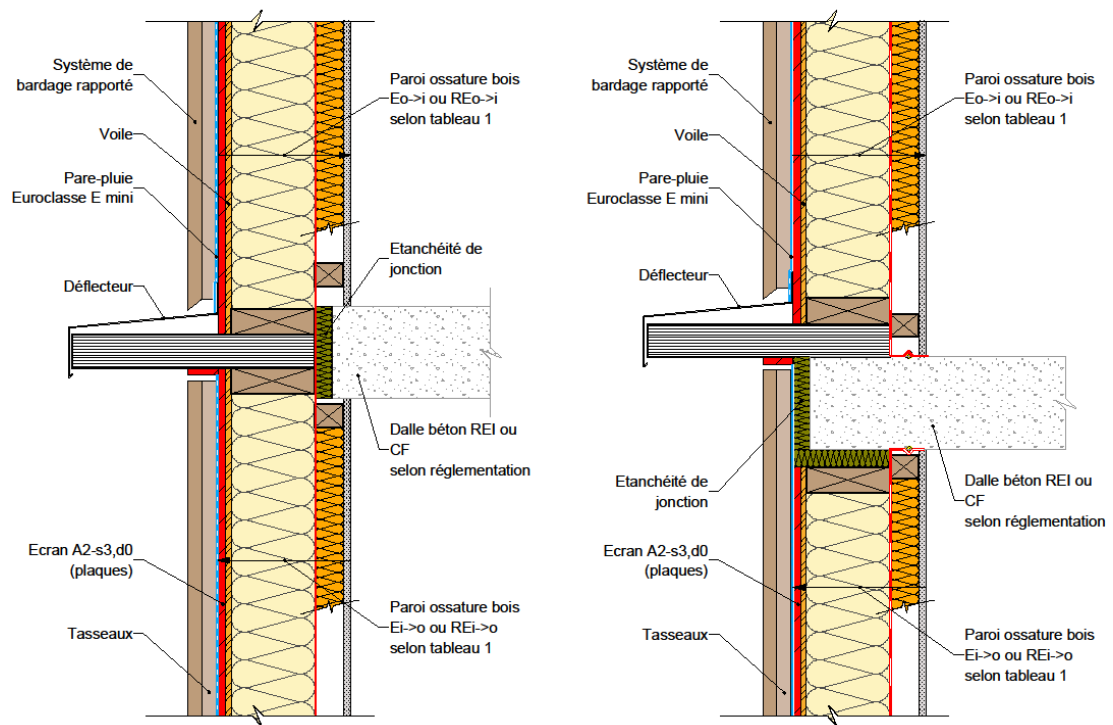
Exemple de paroi avec déflecteurs renforcés d'une façade ossature bois et plancher en béton.
